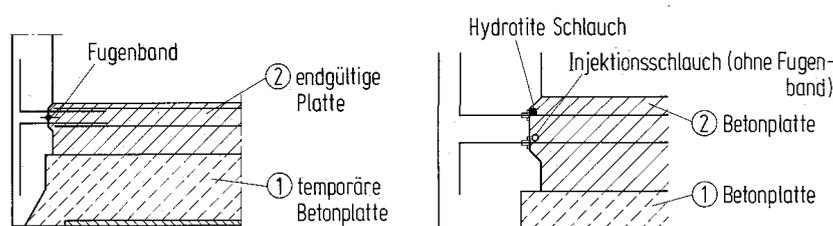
Zweilagige Betonplatte – Alternative Ausführungsvarianten [1]
